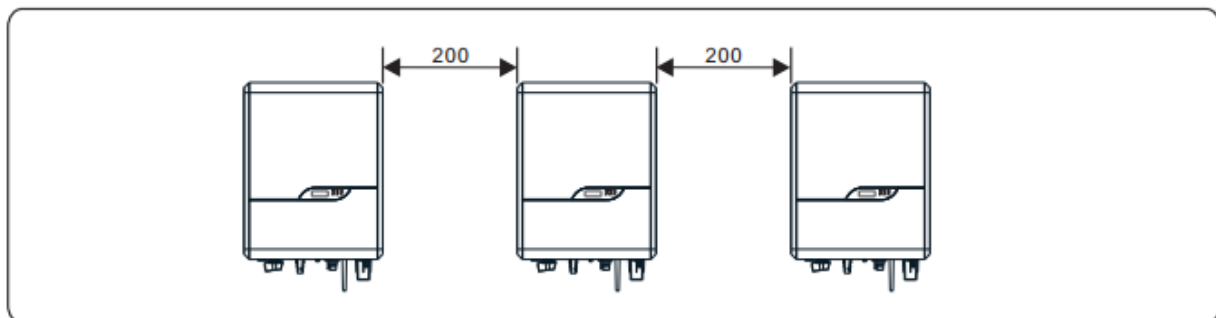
Installazione lungo la stessa linea (unità: mm)
